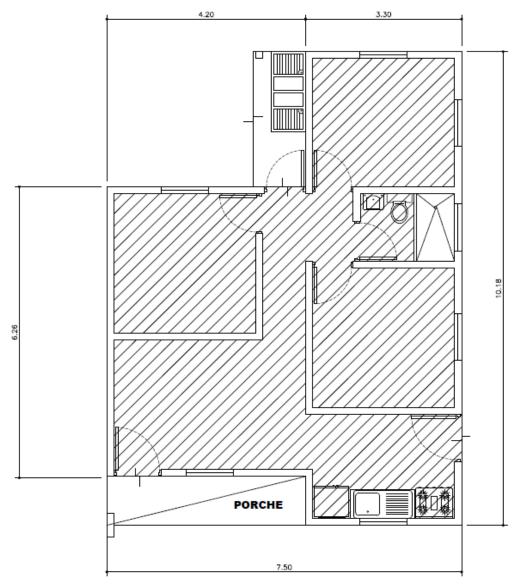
Esquema de planta arquitectónica de la vivienda de la Sra. Elizabeth Rosario Martinez
